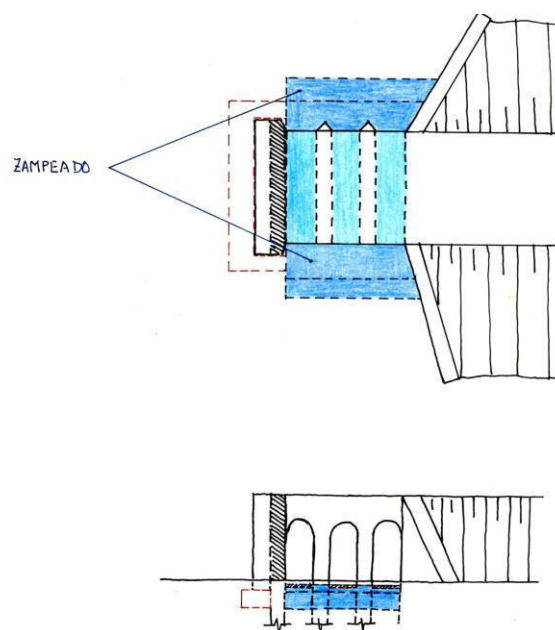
Croquis de la planta y alzado del zampeado de las alcantarillas
